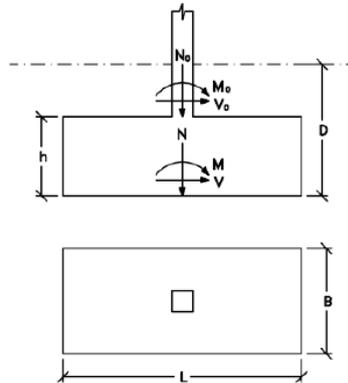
Comprobación de la estabilidad estructural. (Fuente: (Miravete & Larrodé, Los transportes en la ingeniería industrial (teoría), 2002))
